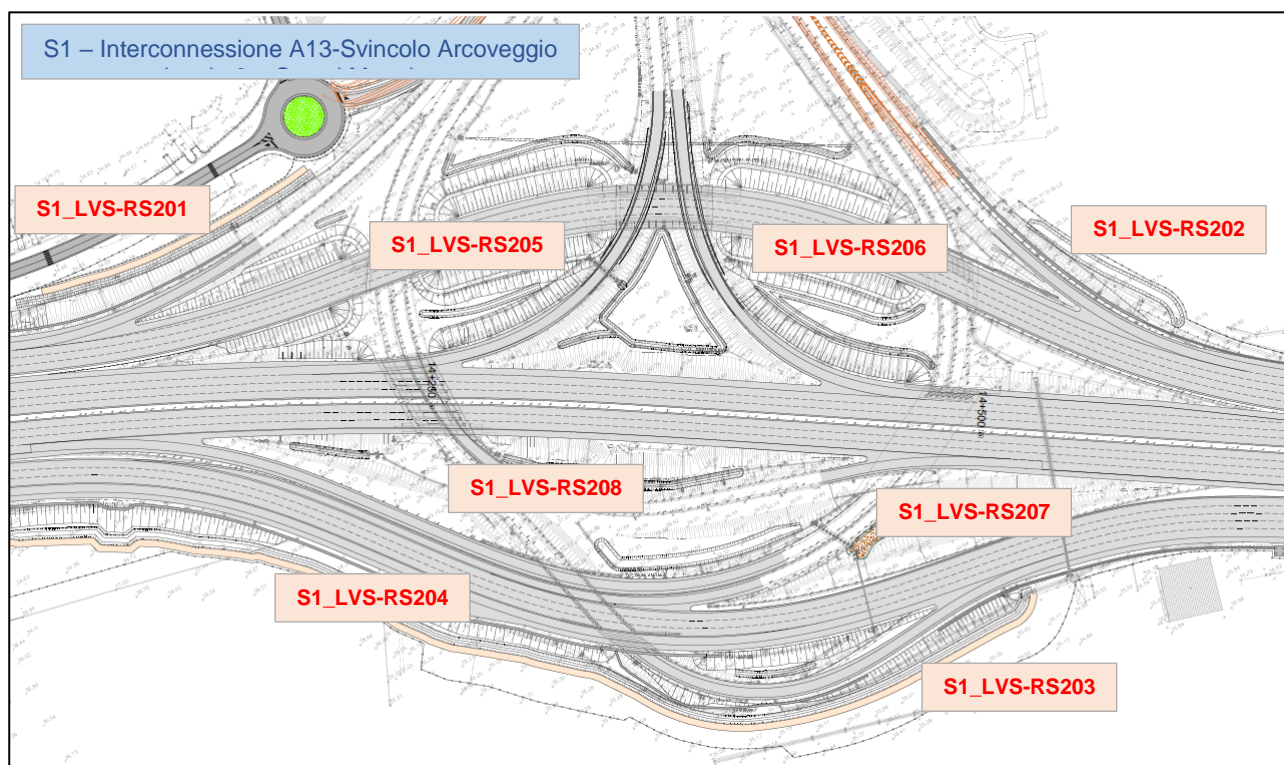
Stralcio planimetrico interconnessione A13-Svincolo Arcoveggio
